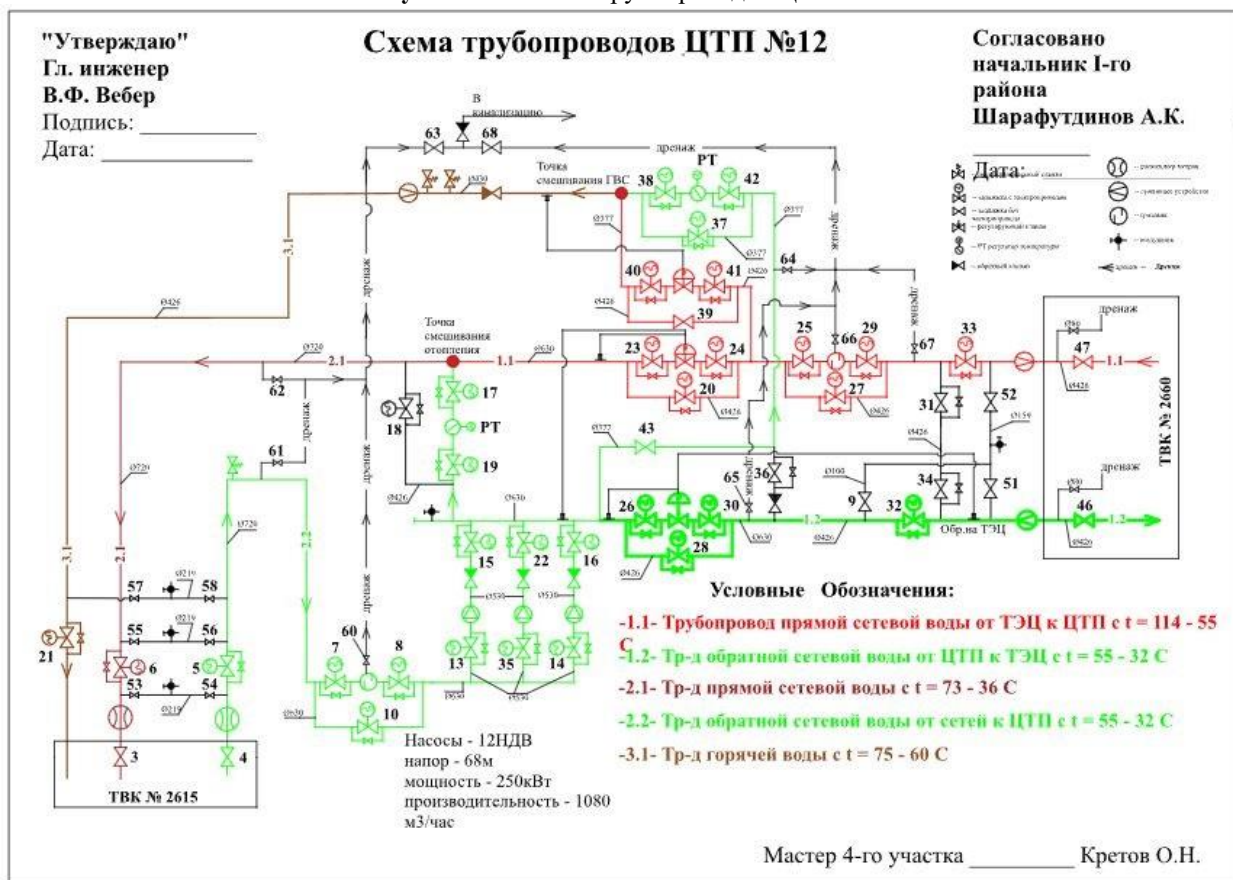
Схема трубопроводов ЦТП №12
